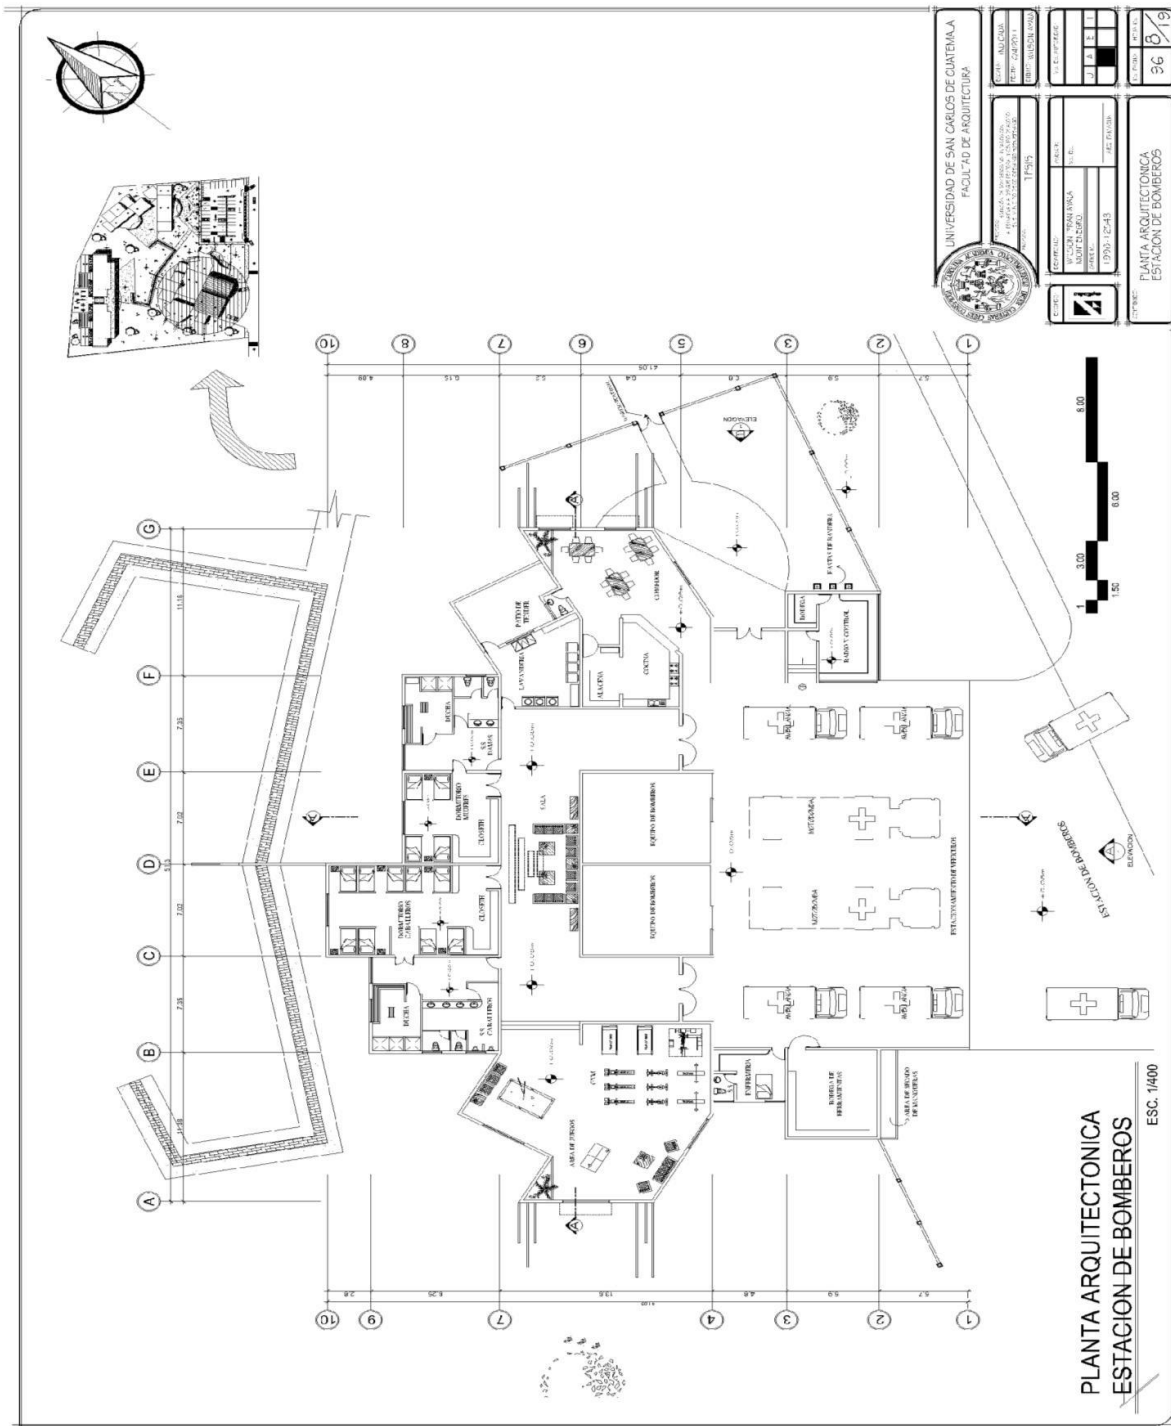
Planta Arquitectónica de la Estación de Bomberos.
